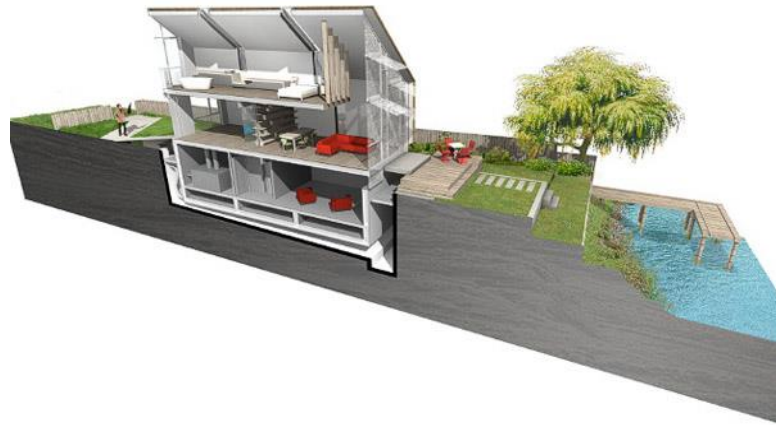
Rumah Amphi dengan konstruksi pondasi busa beton
